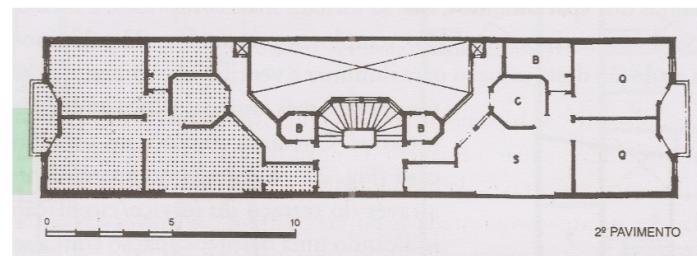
B – Planta baixa “casa de apartamentos”, Rua Bento
